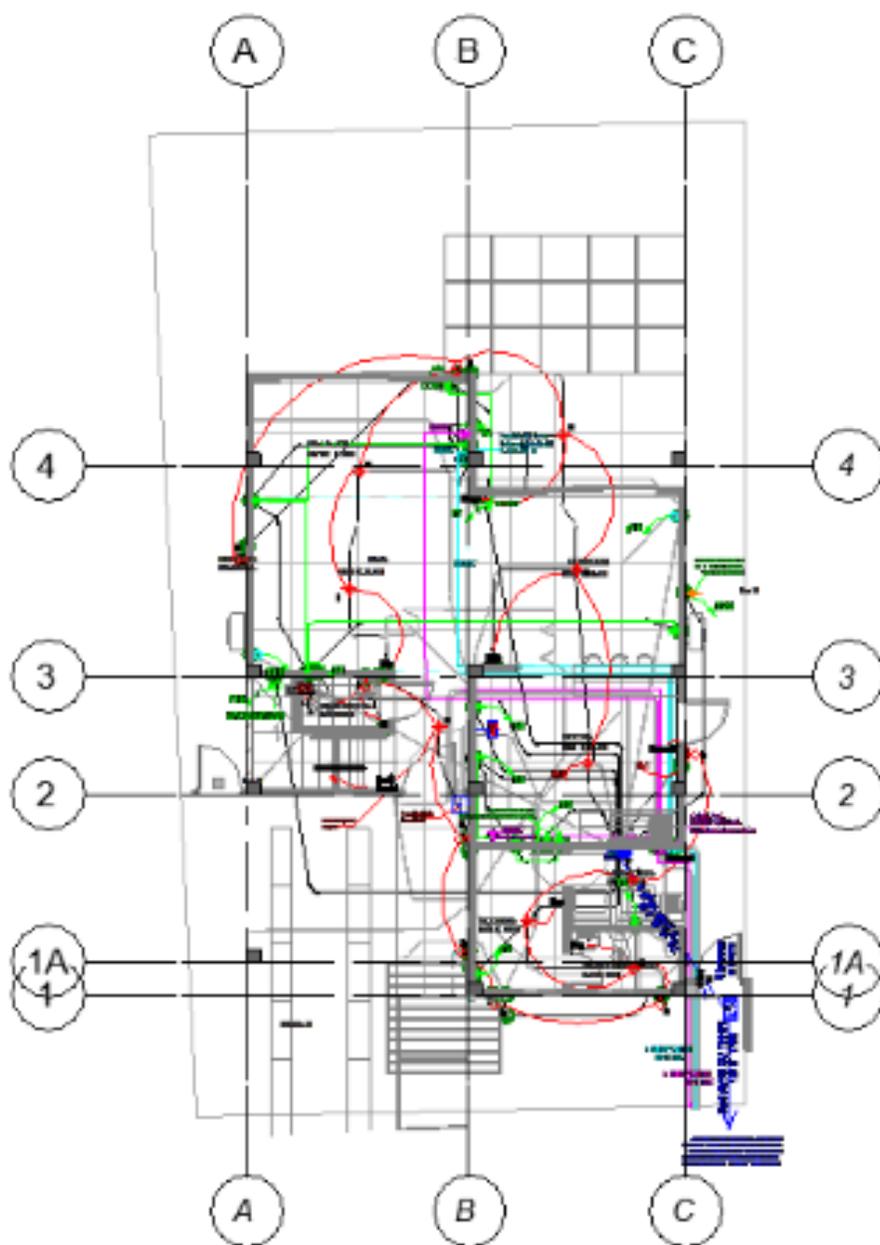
Plano de instalaciones eléctricas de planta alta en Revit. (Autor)
